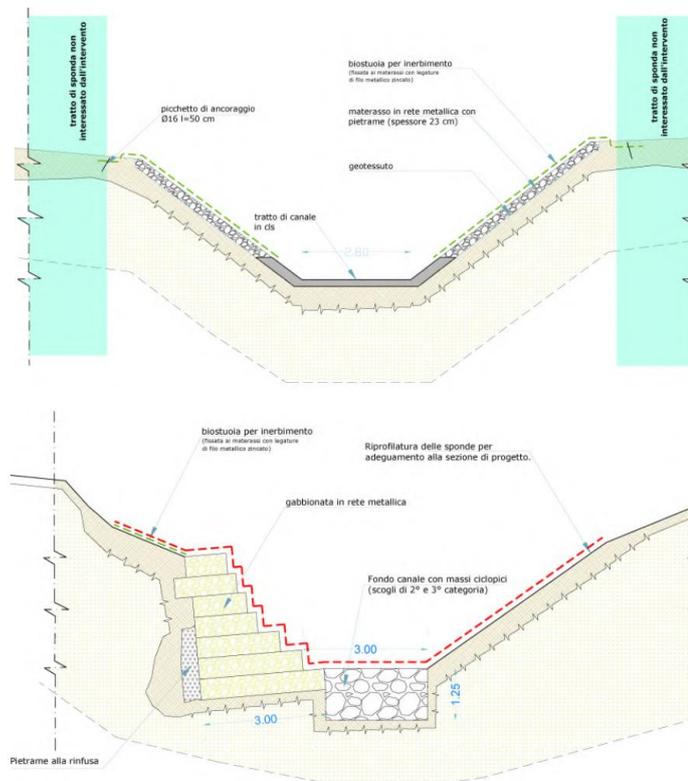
Sezione tipologica - Intervento di stabilizzazione spondale con gabbionate di pietrame
